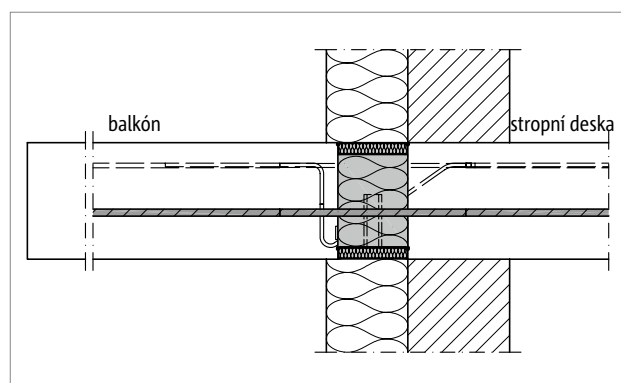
Schöck Isokorb® XT typ HP: Volně vyložený balkón
